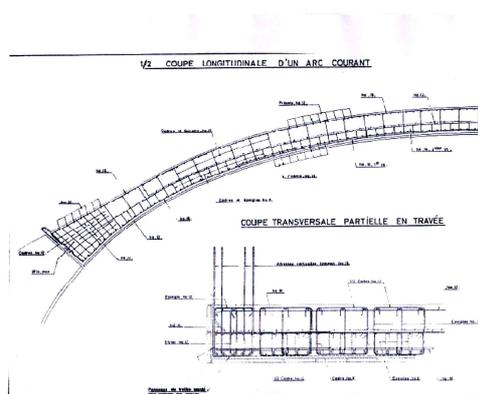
Ferrailage des voûtes des arches en béton armé.
